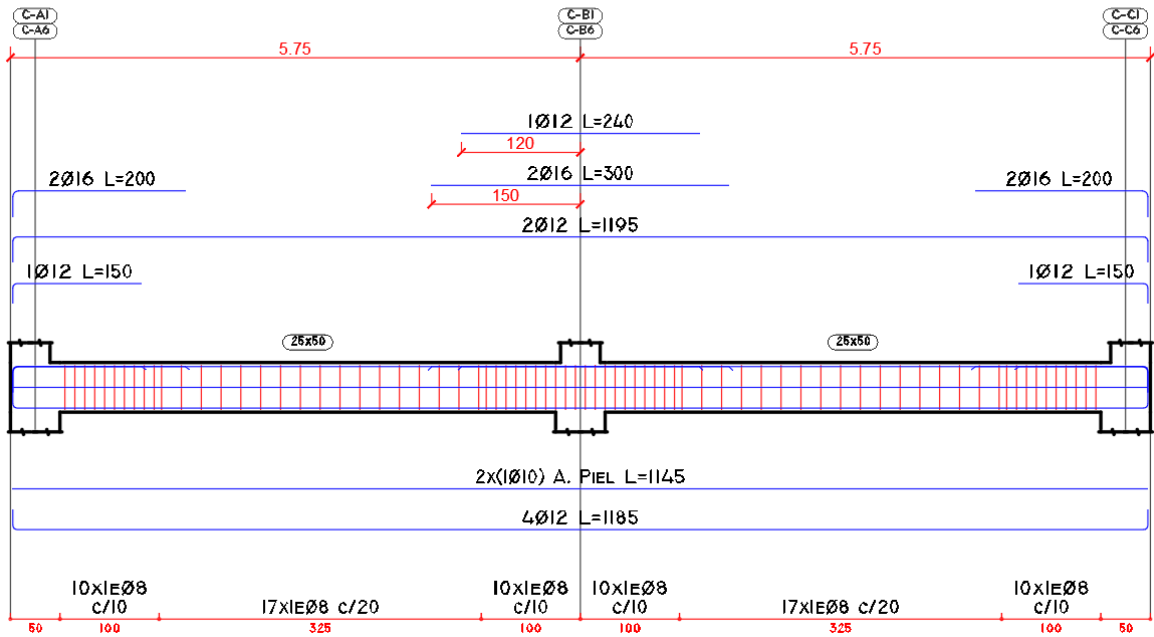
Detalle de Refuerzo Vigas en "X" Piso 1 a 4, Estructura [7N-CS].
